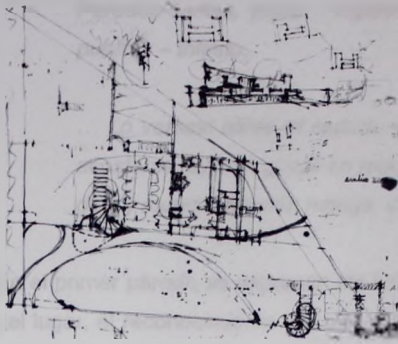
Croquis de planta de conjunto, Casa Medina 2001
